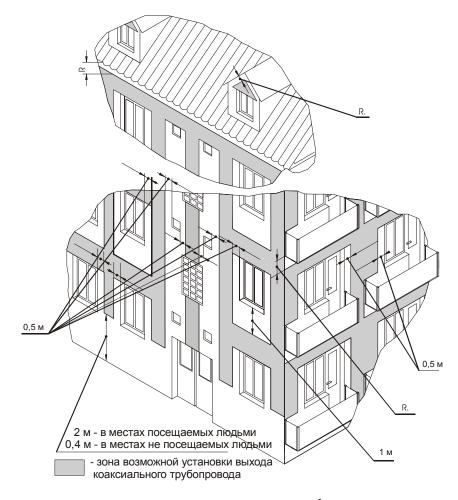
Размещение выхода коаксиального дымохода на фасаде здания
